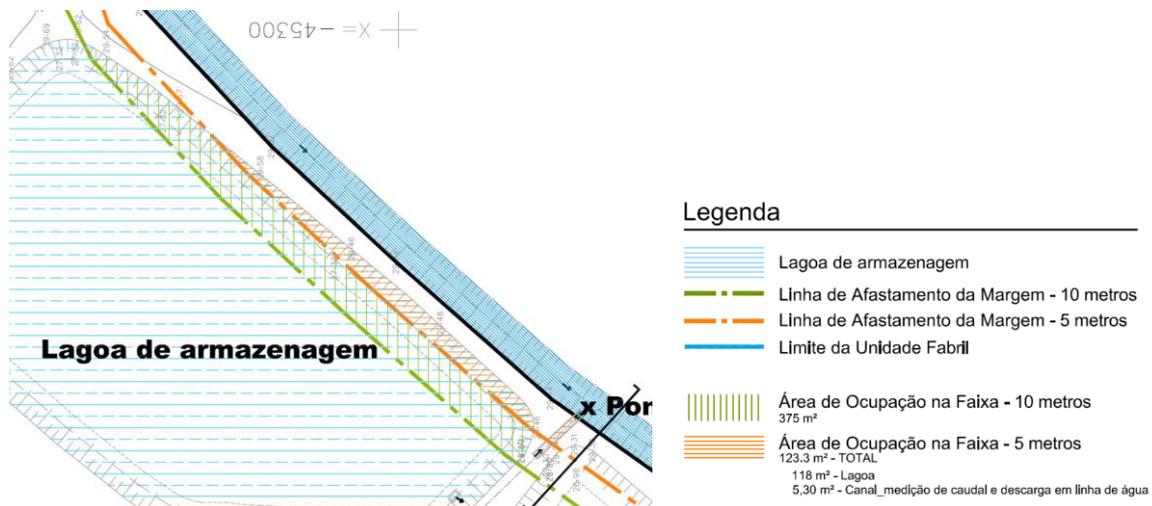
Extrato da planta [8.19 Planta02 Sintese.pdf](#) [REQ\_CONS\_314977]
